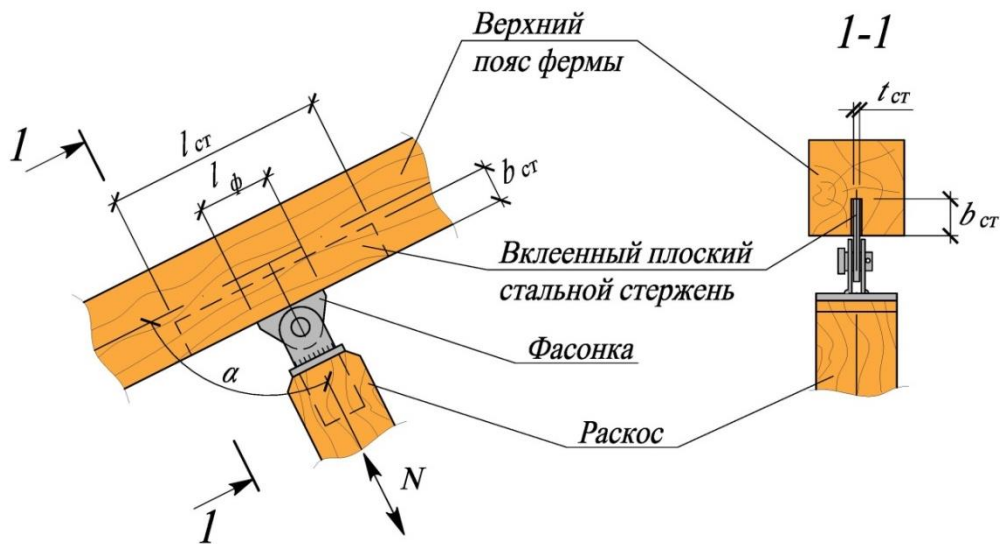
Конструктивное решение узла сопряжения раскоса с верхним поясом деревянной фермы при помощи вклеенных стальных плоских стержней
